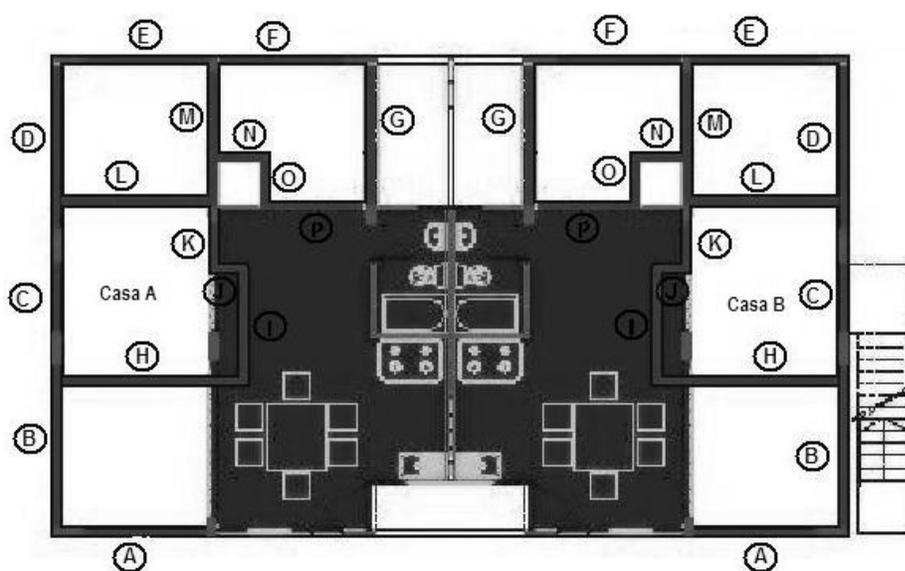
Planta de modulación de tabiques Casas A y B. Fuente: Elaboración propia.
